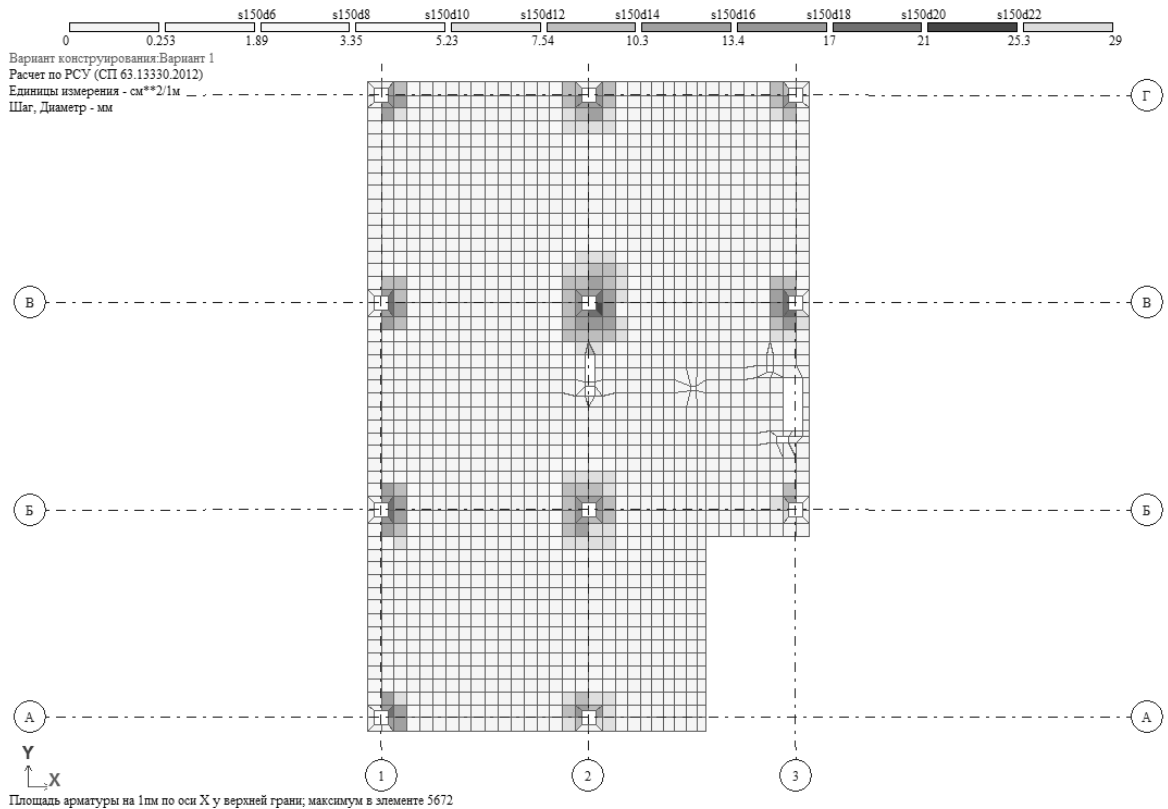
Армирование плит перекрытия по оси X у верхней грани
